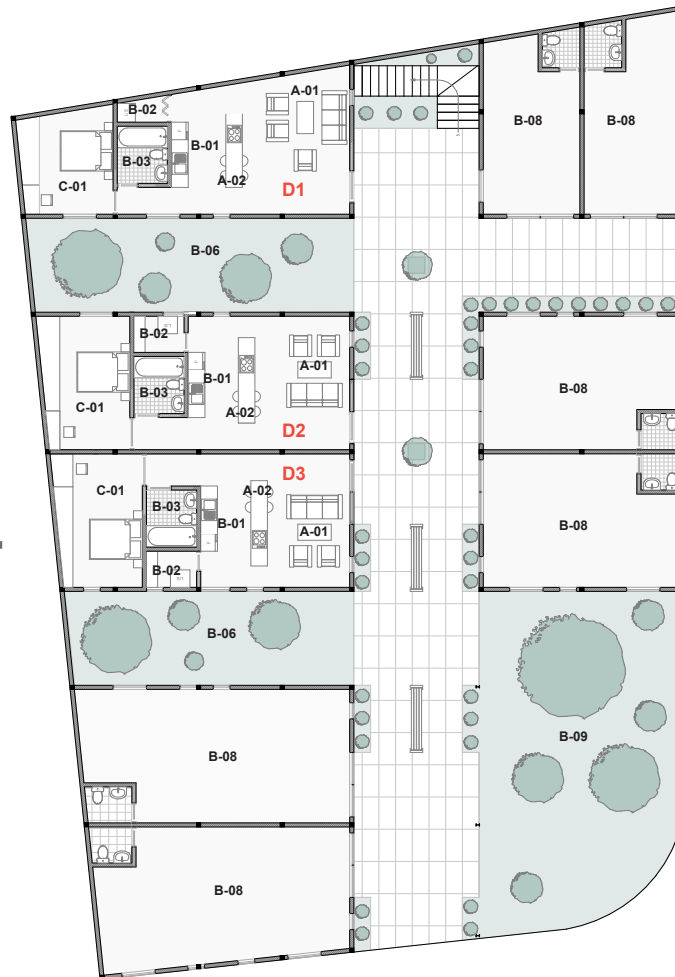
Planta Baja. Elaborado por Grupo de Tesis.
